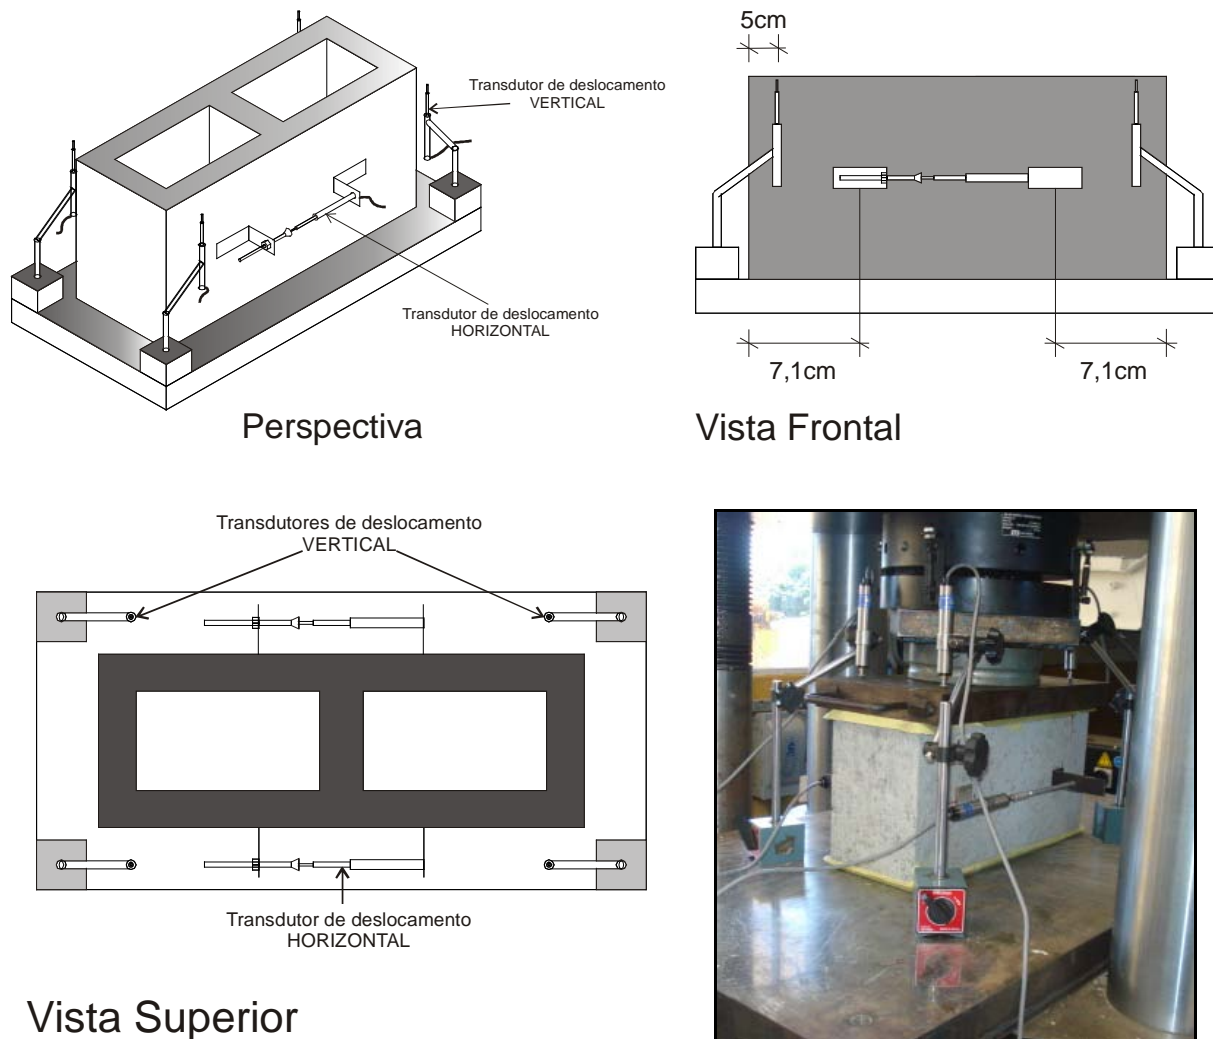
Instrumentação do bloco para ensaio à compressão axial.
